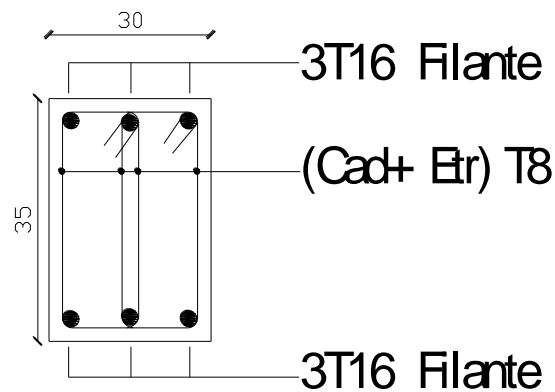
Ferrailage en travée d'une poutre secondaire Sur appuis :
